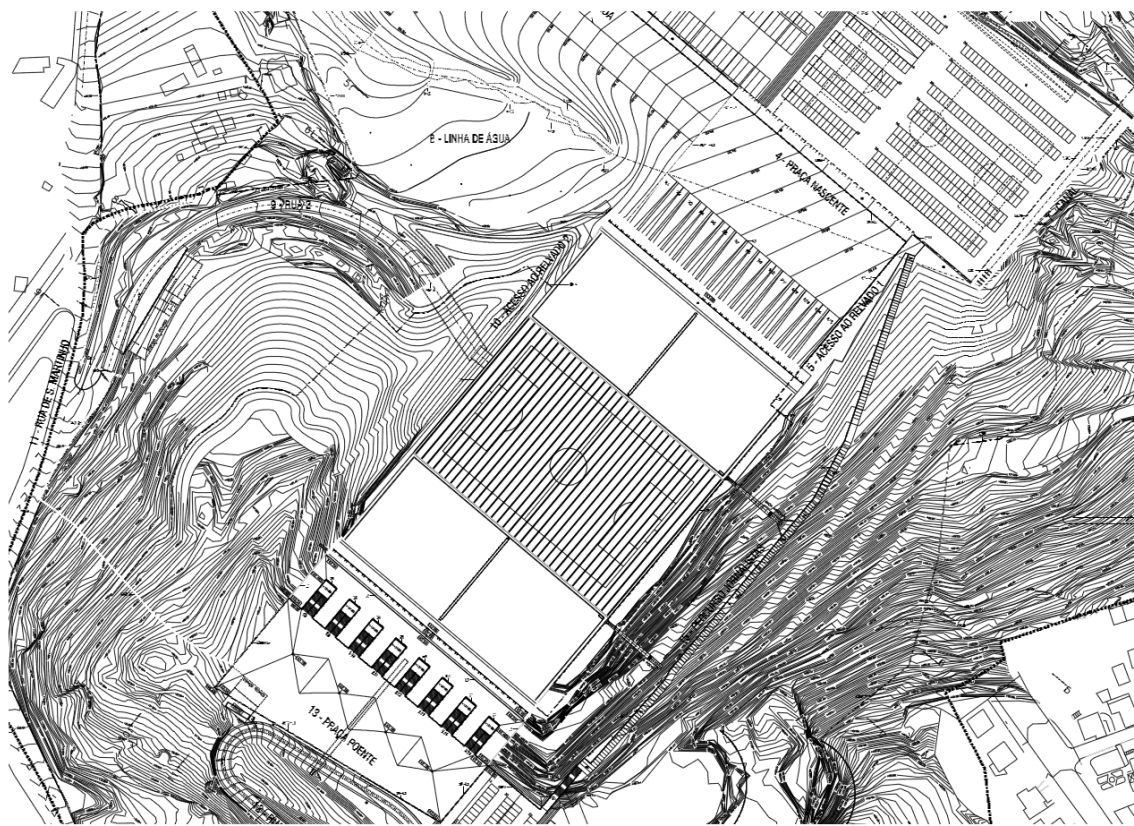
Planta de implantação, Eduardo Souto Moura, 2003
